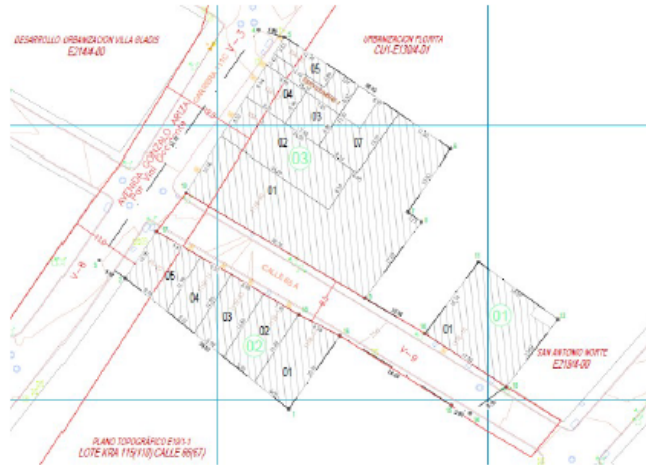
Plano Loteo Ajustado Sector Villa Gladys
